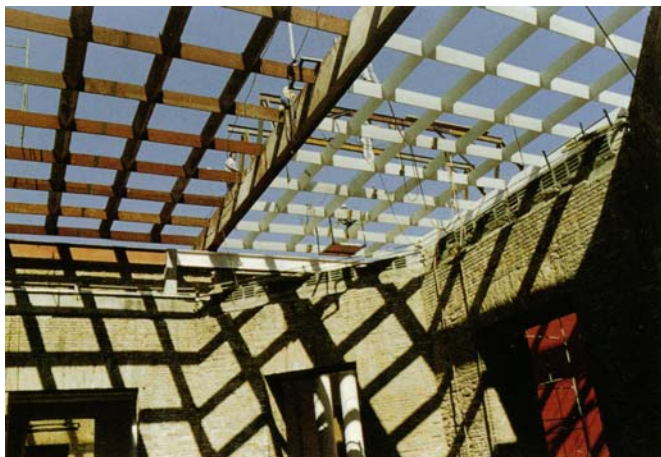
Construção e instalação da nova cobertura (1997).
